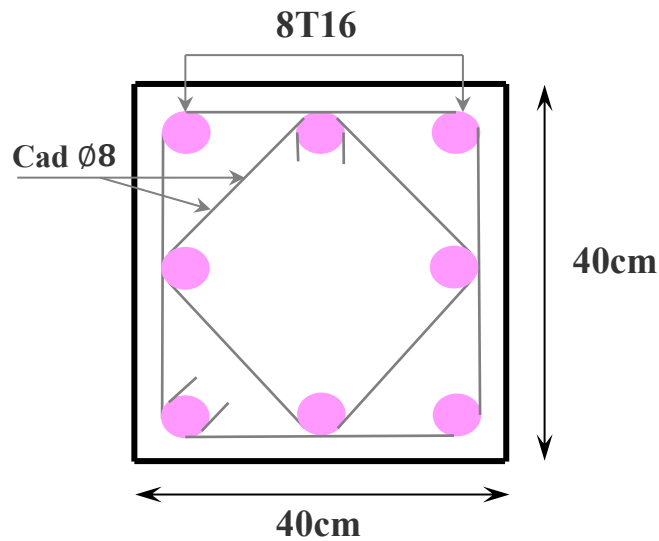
Schéma de ferraillage des poteaux 40x40.
